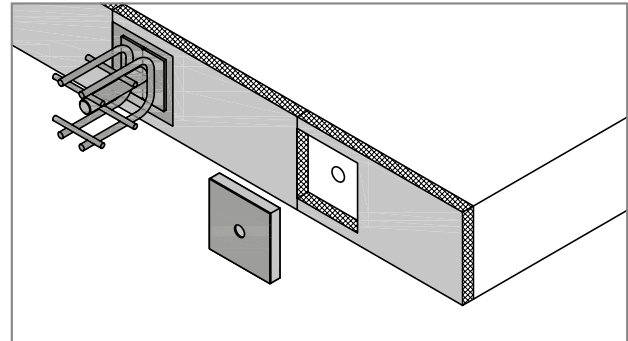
Disposition du Schöck manchette coupe-feu dans le joint
